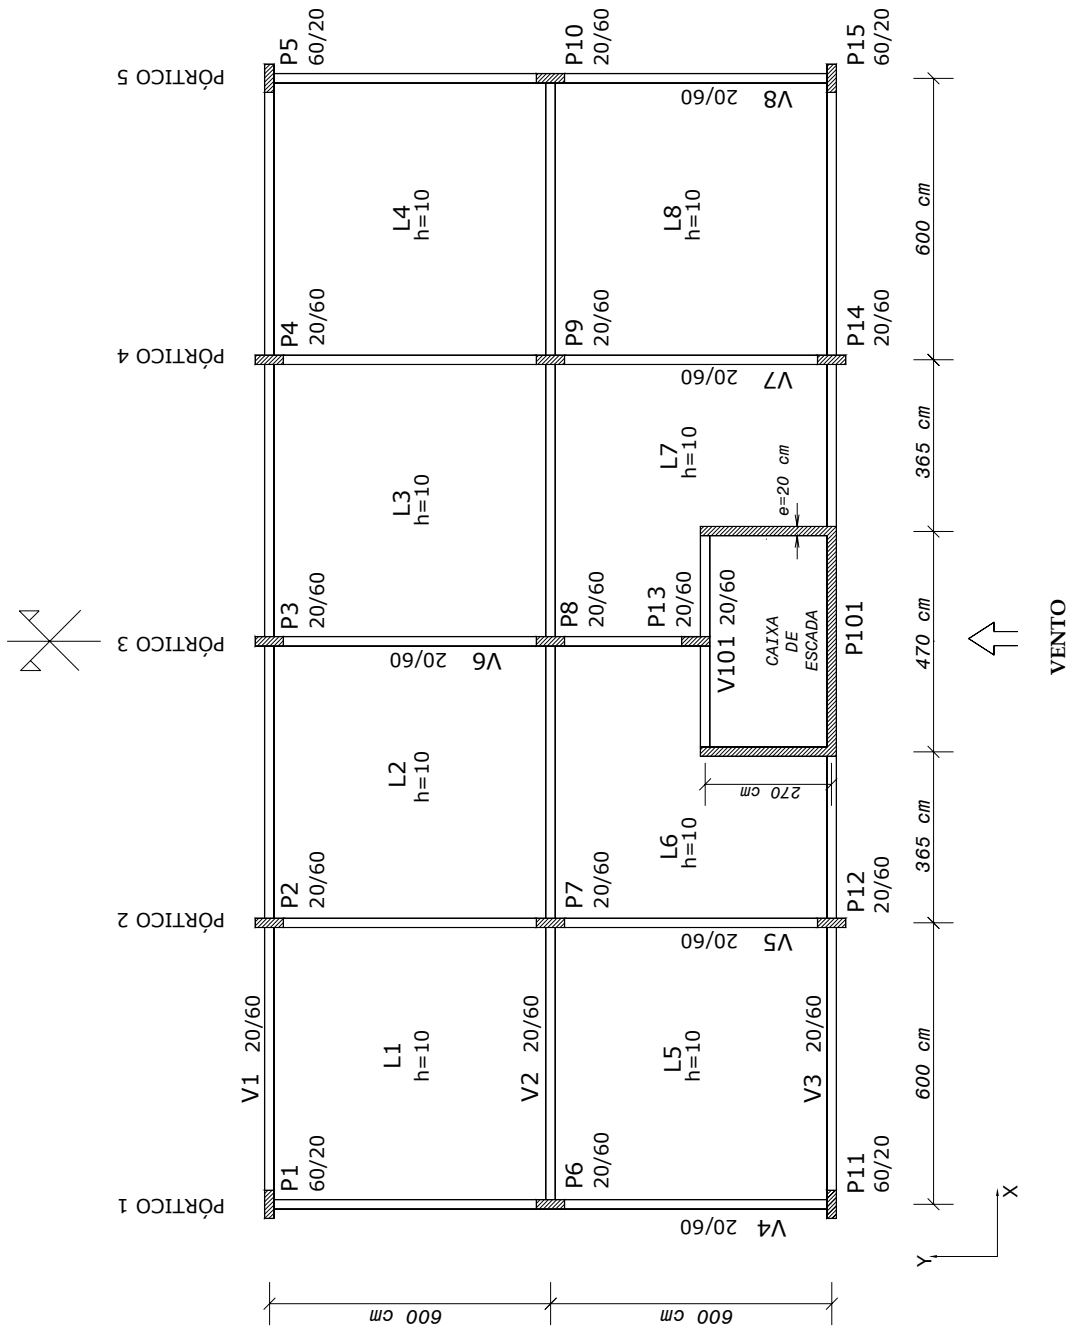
Forma do pavimento tipo da Estrutura 3.
